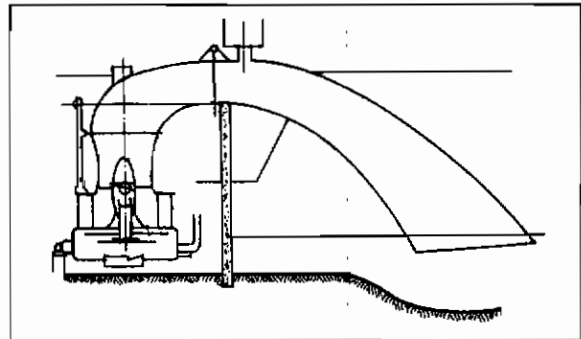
Turbina axial de tipo bulbo con sifón.
